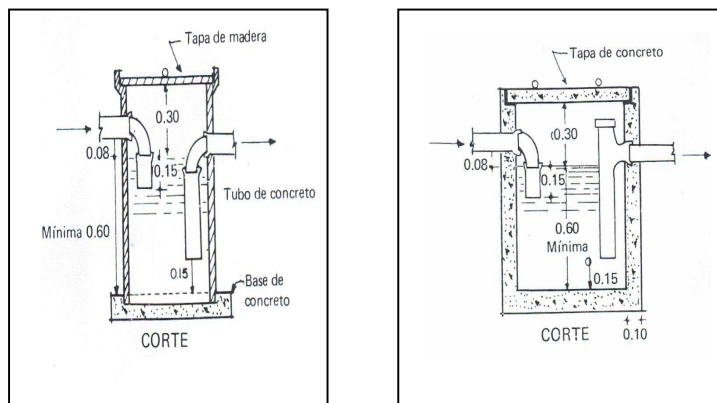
Sección del canal de sistema de alcantarillado interno de una planta de servicio automotriz
